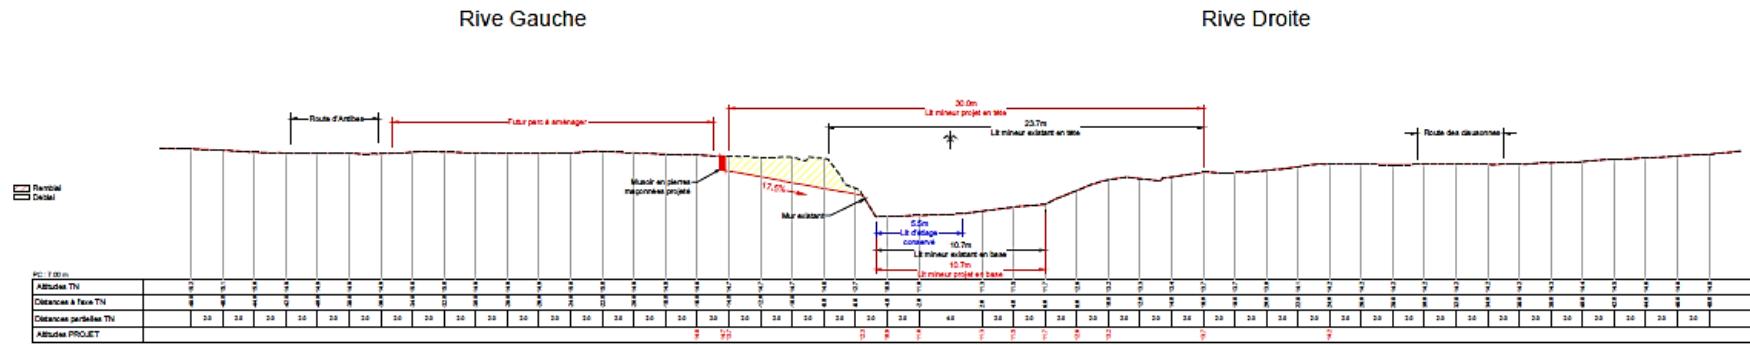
Coupe de profil n° P42. L'emplacement du profil est reporté sur la Figure 2 ci-avant.
